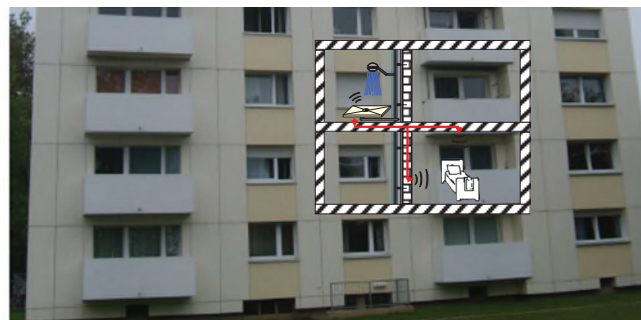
Musterbau-Installationsprüfstand als Gebäudeausschnitt aus dem Geschosswohnungsbau.
